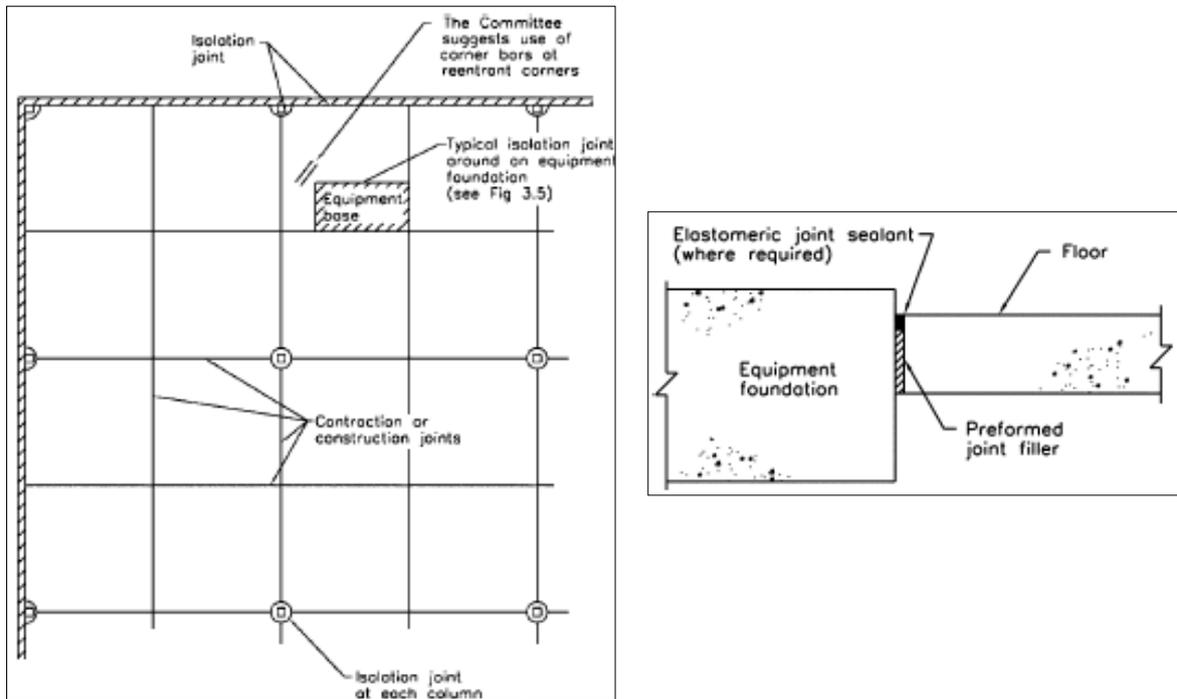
À esquerda: localização de juntas aconselhada pela ACI. À direita: pormenor típico de junta de isolamento em redor da fundação de um equipamento [6]
